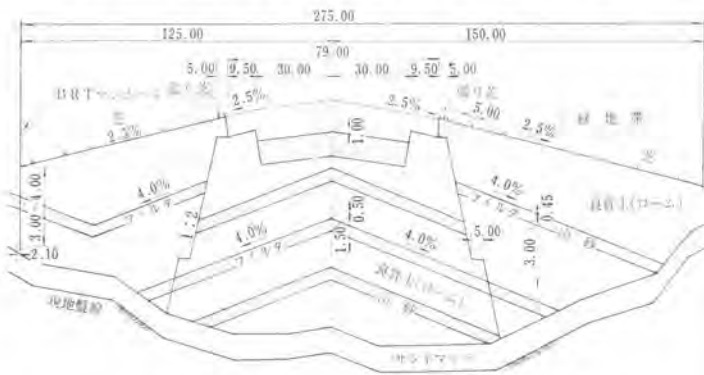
フィルタ工A滑走路標準横断面図(盛土部)
